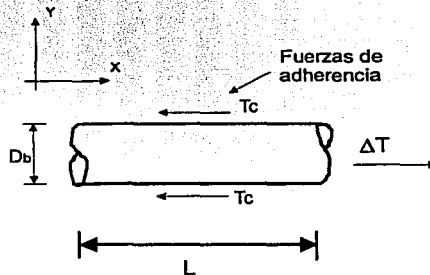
Estado de fuerzas en un segmento de barra de refuerzo longitudinal
